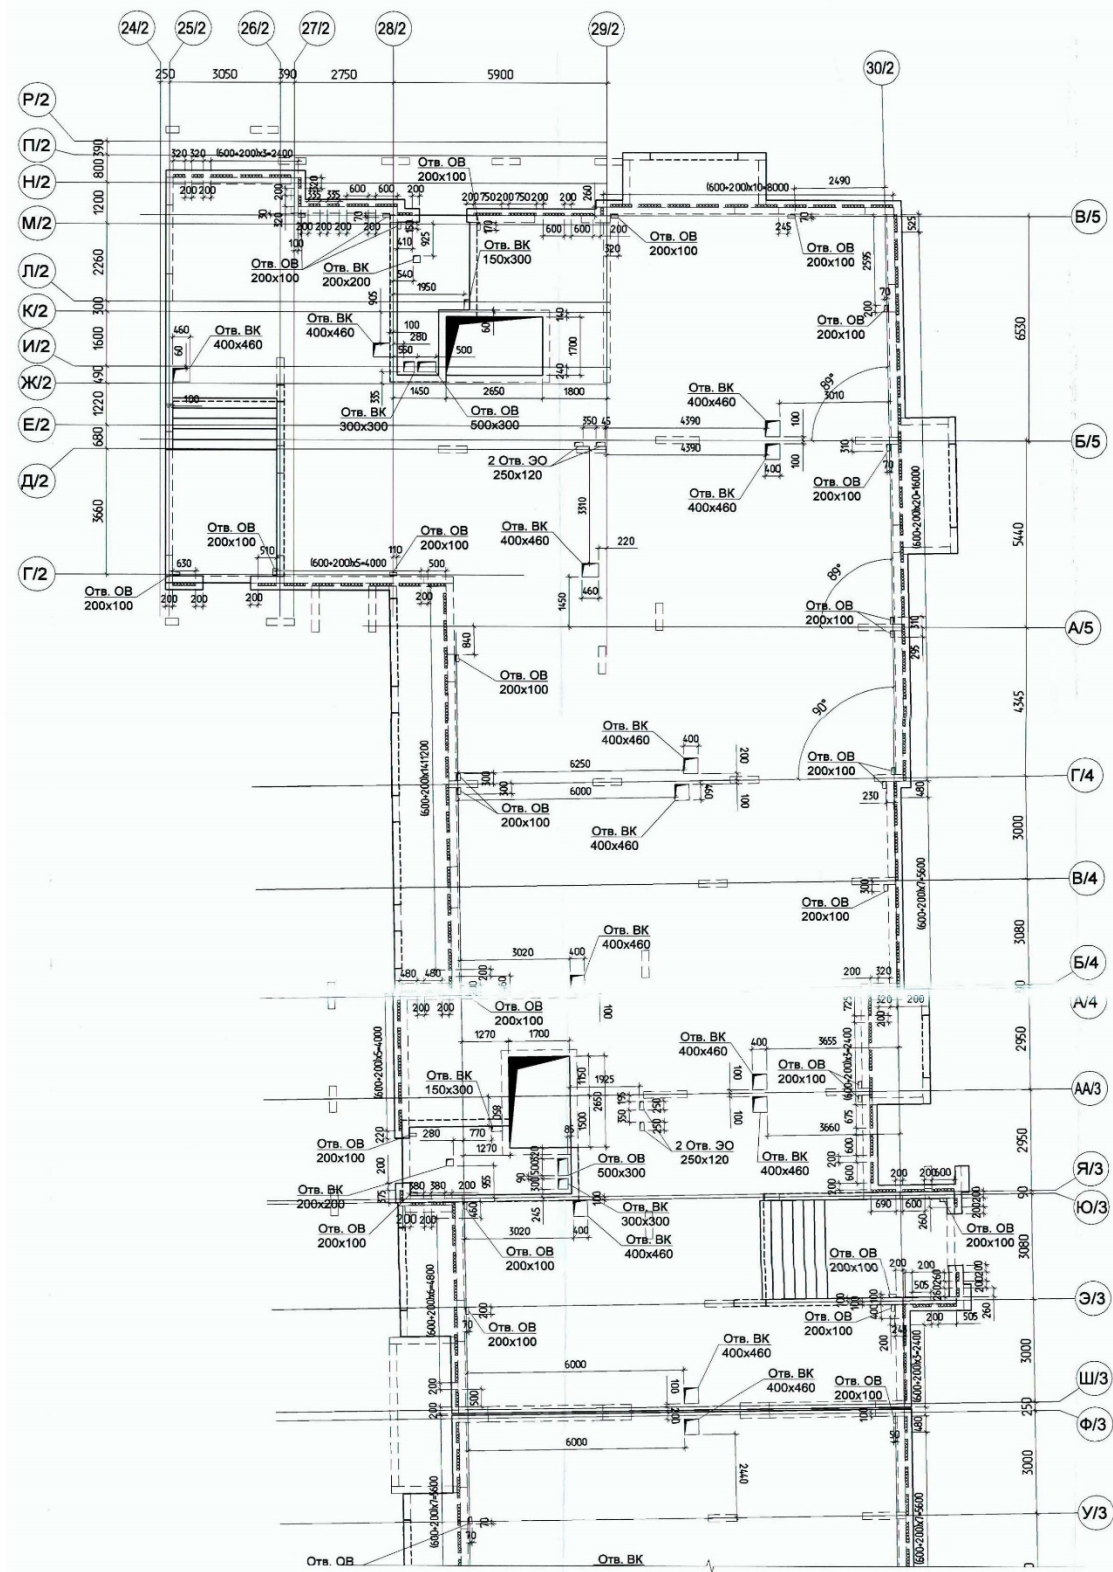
Плита перекрытия подвала 4, 5, 6, 7 секции
